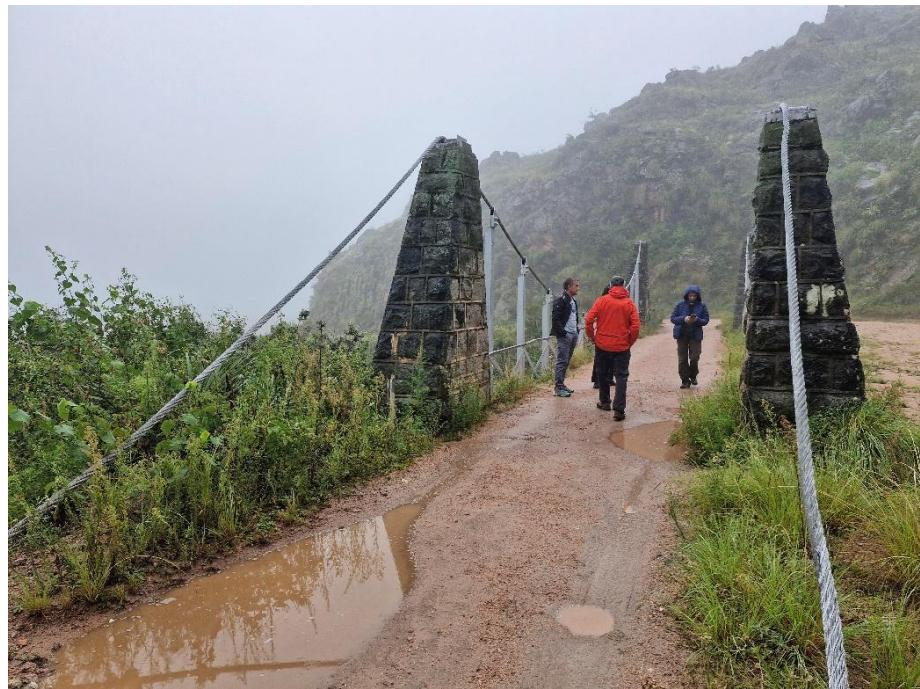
Fotografía actual del Puente N° 1 (Prg. Km 3,71). Se aprecia la infraestructura conformada por una viga metálica
